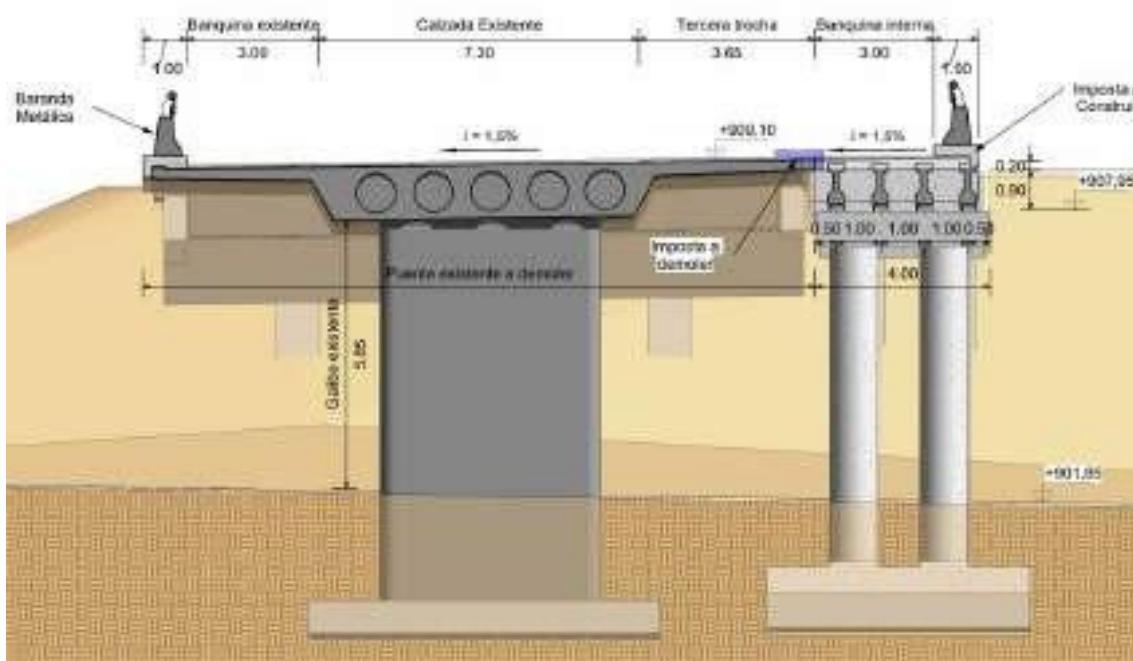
Sección Transversal Puente Calle Bulnes - Obra nueva y obra a conservar
